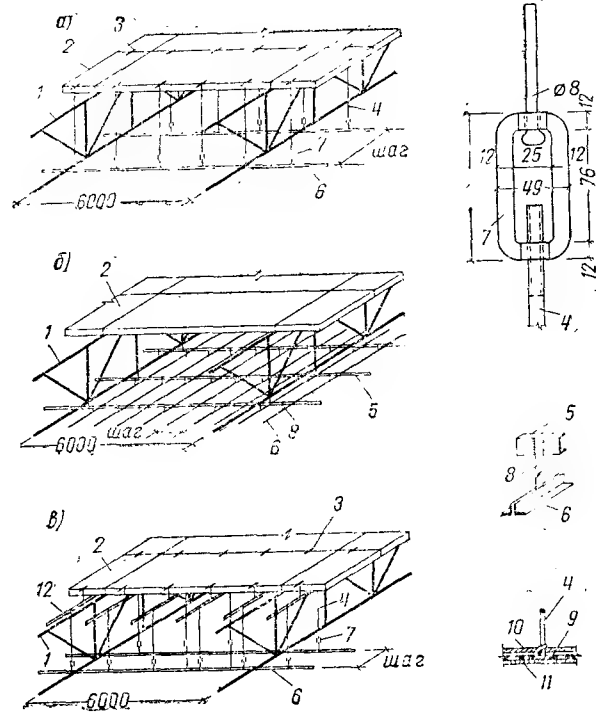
Крепление подвесных потолков к фермам при шаге 6 м
